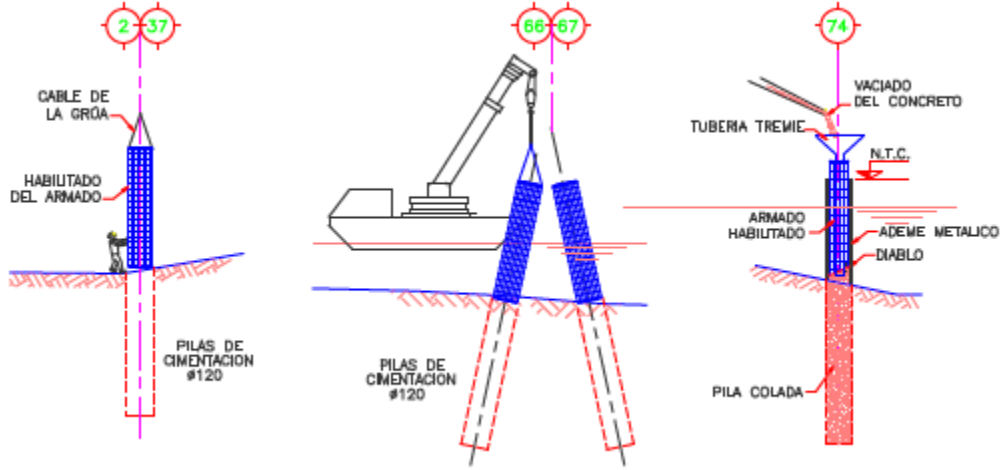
Procedimiento para el armado y colado de las pilas de cimentación.
